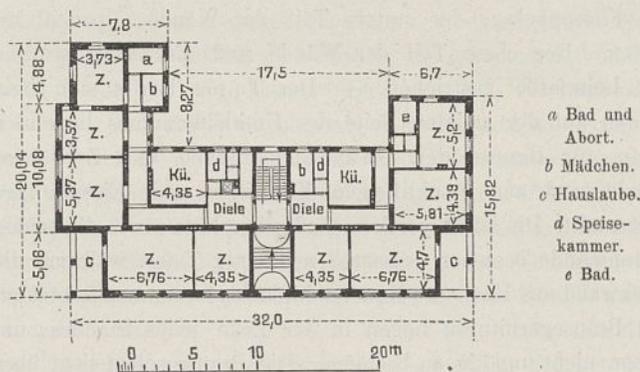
Beamtenwohnhaus. Erdgeschoß.
